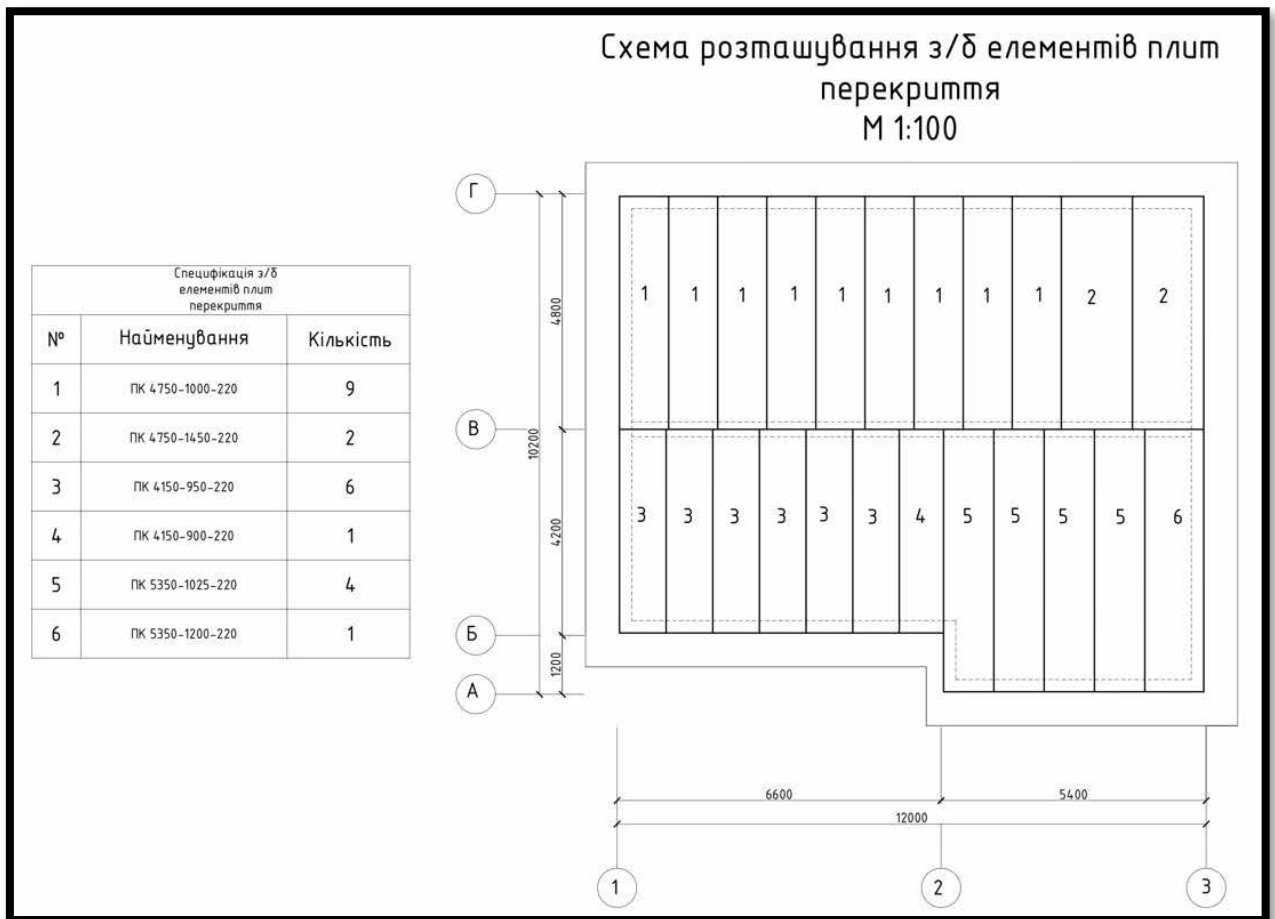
Схема розташування залізобетонних елементів плит перекриття та специфікація
